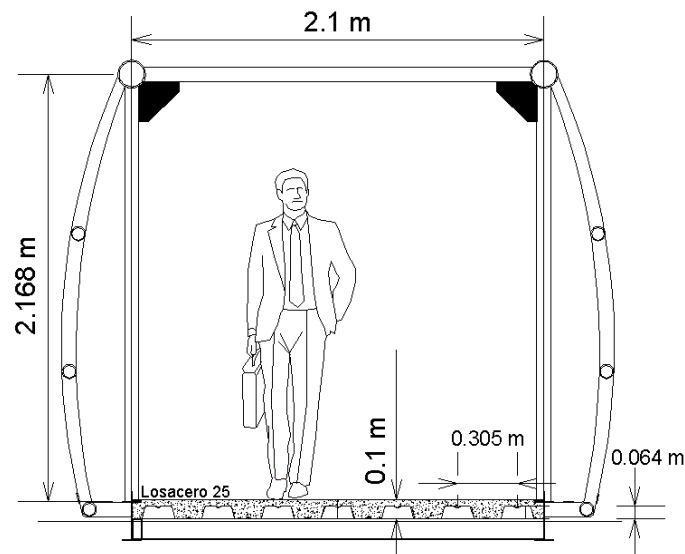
Detalle de la sección transversal de la calzada peatonal del puente peatonal San Bartolo
